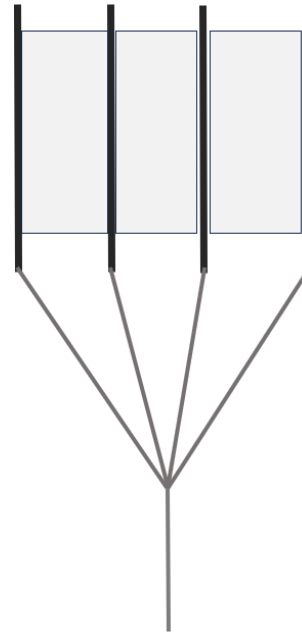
Ejemplo de estación en fondo de saco (Fuente: Propia)
